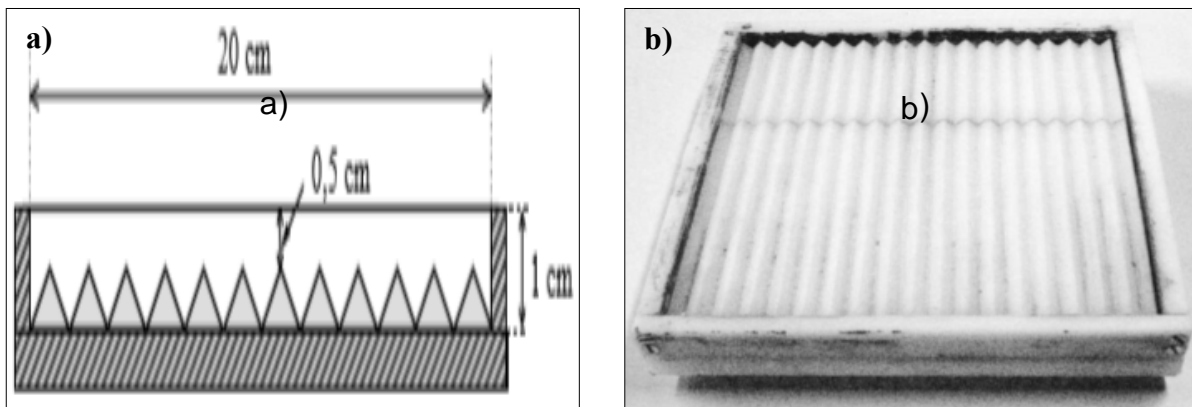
a) Vue en coupe du dispositif de fissuration des mortiers, b) Dispositif de fissuration pour mortier à l'état frais [15]
